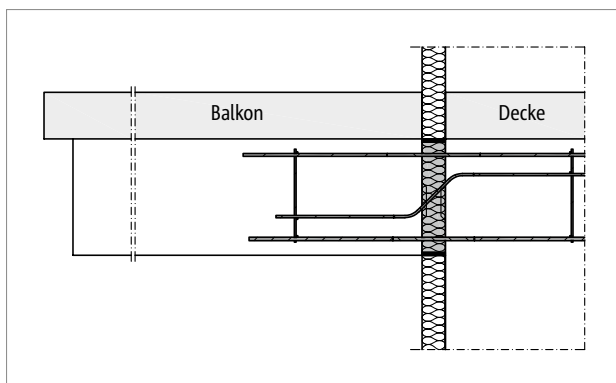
Schöck Isokorb® T Typ BP: Balkonkonstruktion mit frei auskragenden Unterzügen (Fertigteilbalkon)
